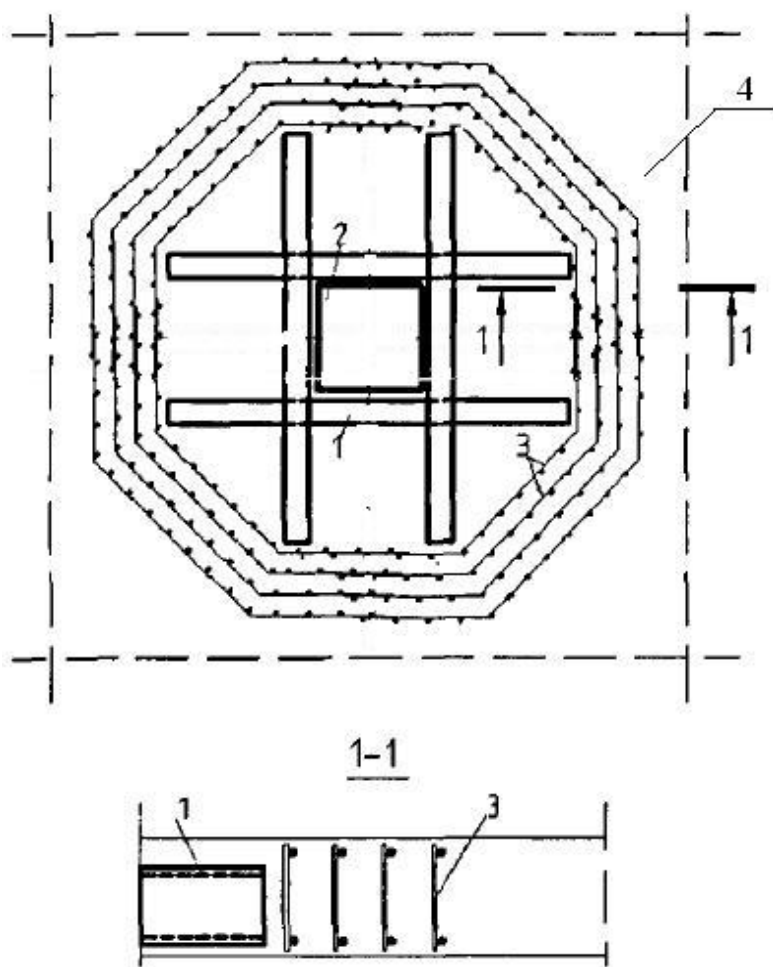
Стыковое соединение безребристой плиты с жесткой арматурой и стержневыми хомутами
